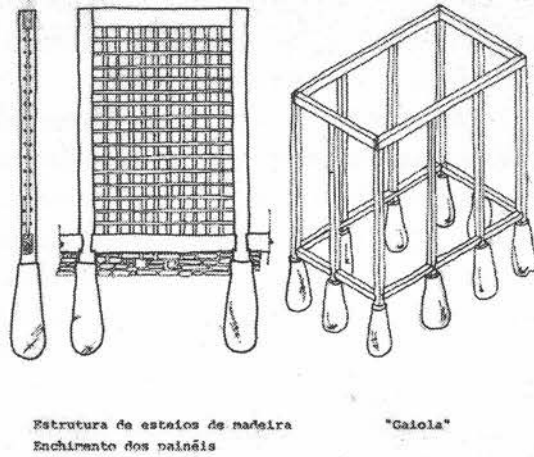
Estrutura de madeira para a execução da taipa de mão
